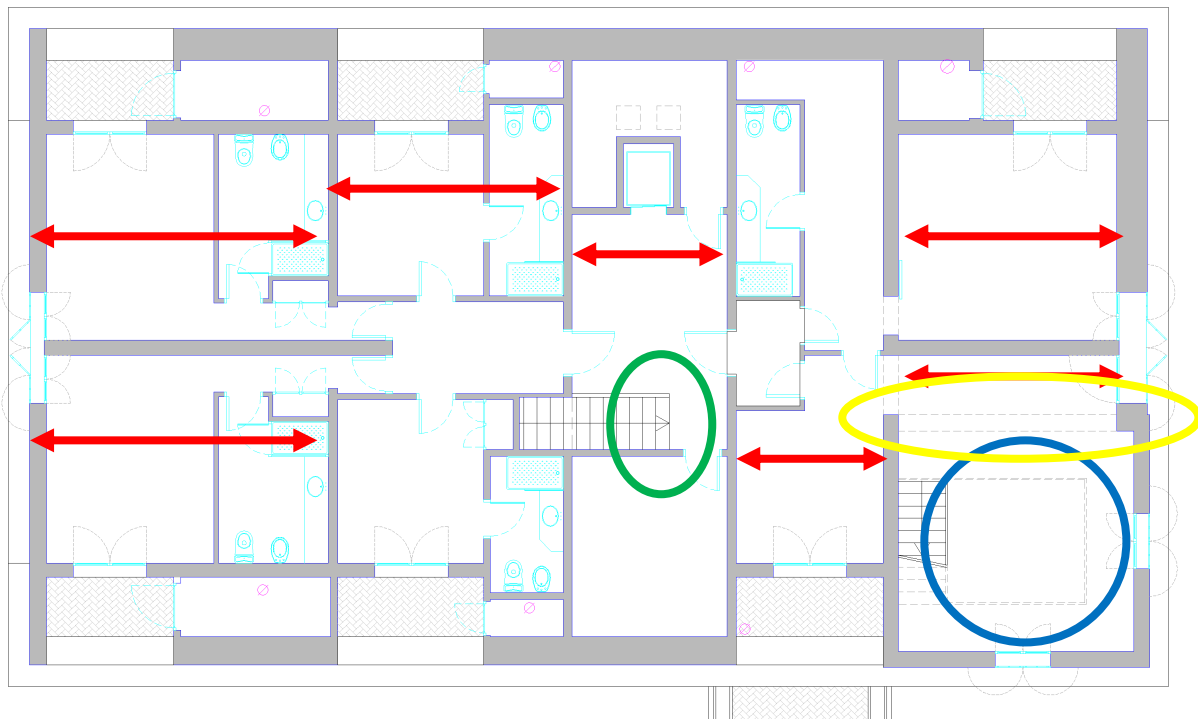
Plano planta segunda (Fuente: Propia)
